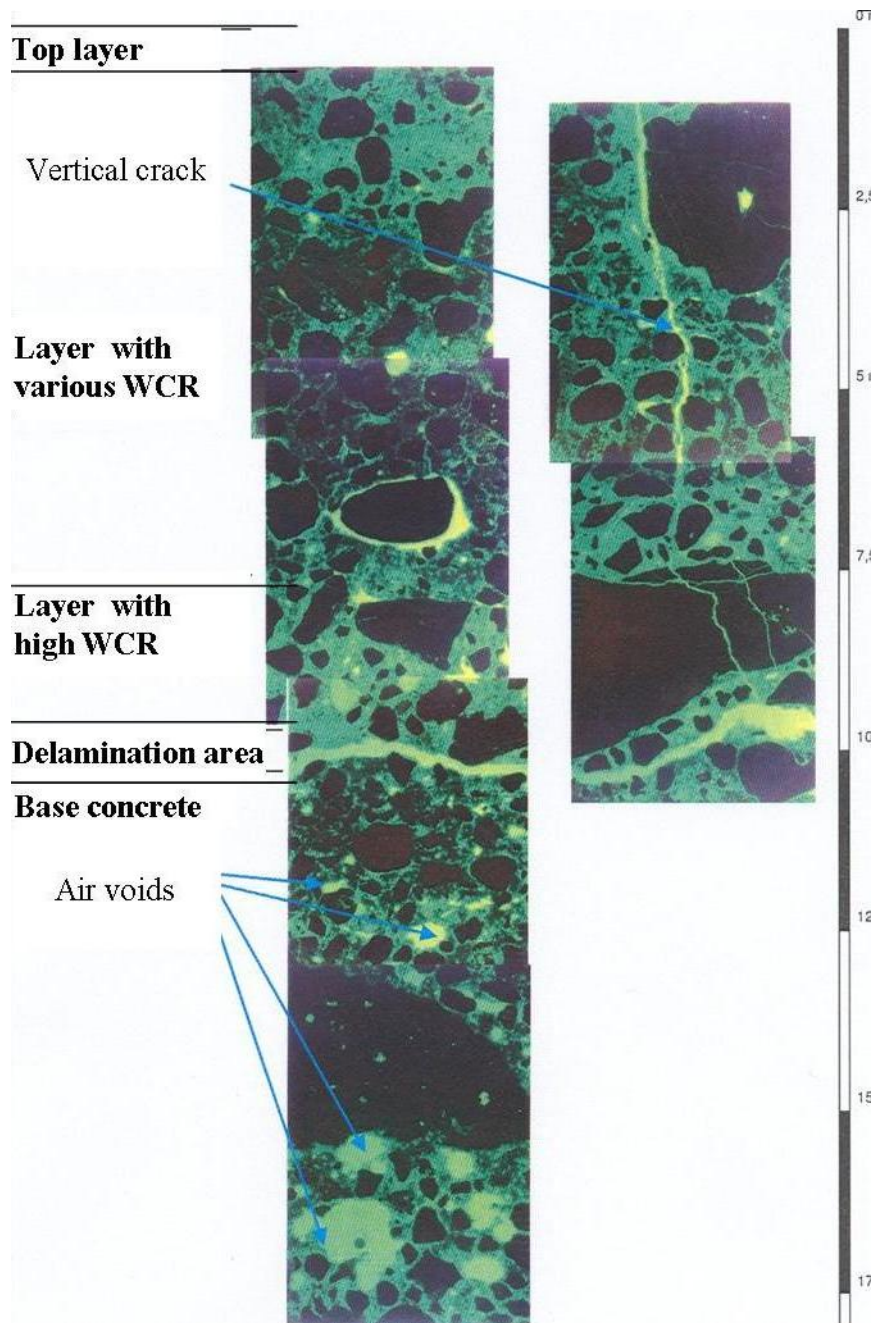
Beispiel einer Oberflächenablösung in einer Zone mit erhöhtem Wasser-/ Zementwert in Bezug auf den unteren Beton.
